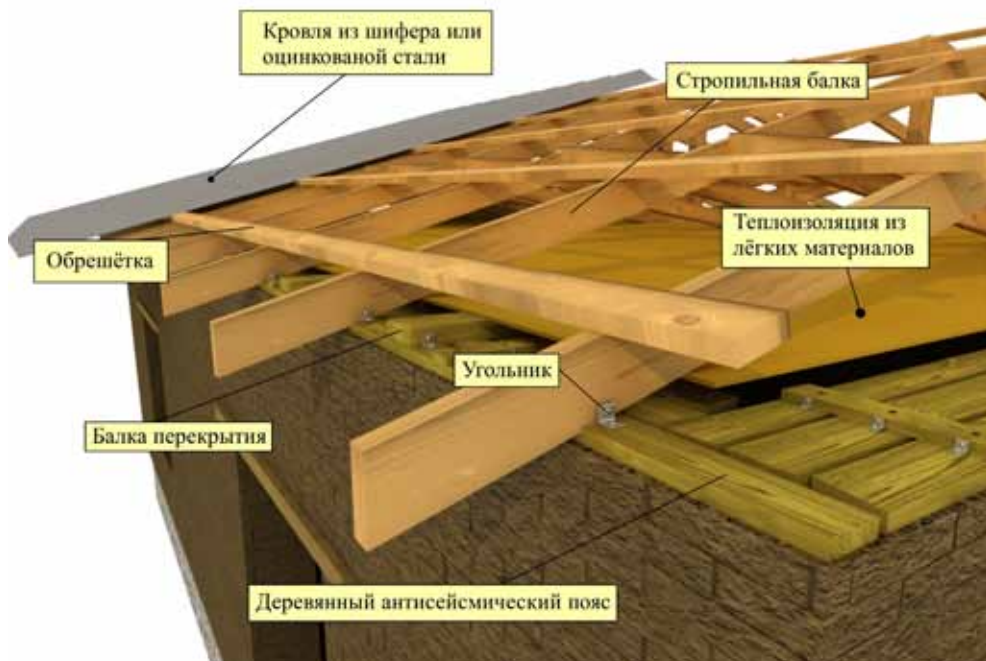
Крепление балок перекрытия и стропильной балки к антисейсмическому поясу
